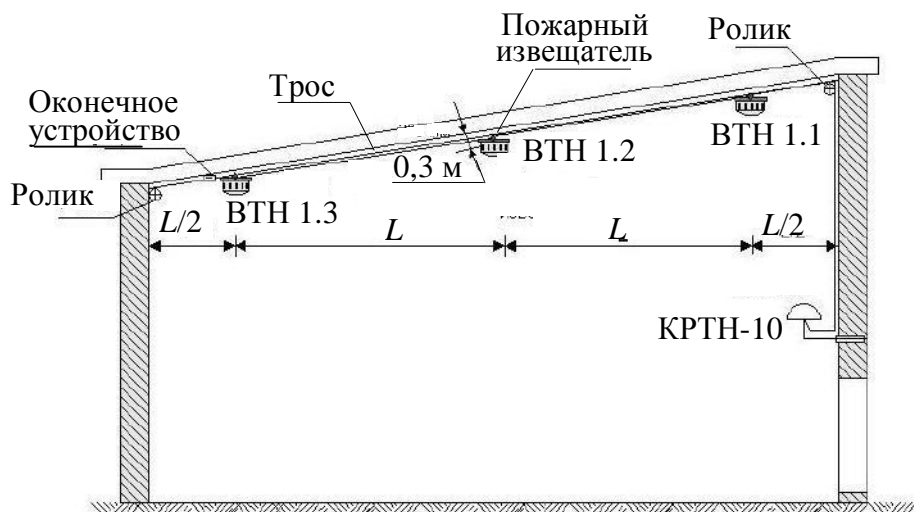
Вариант схемы размещения АПИ на тросах под перекрытием здания
